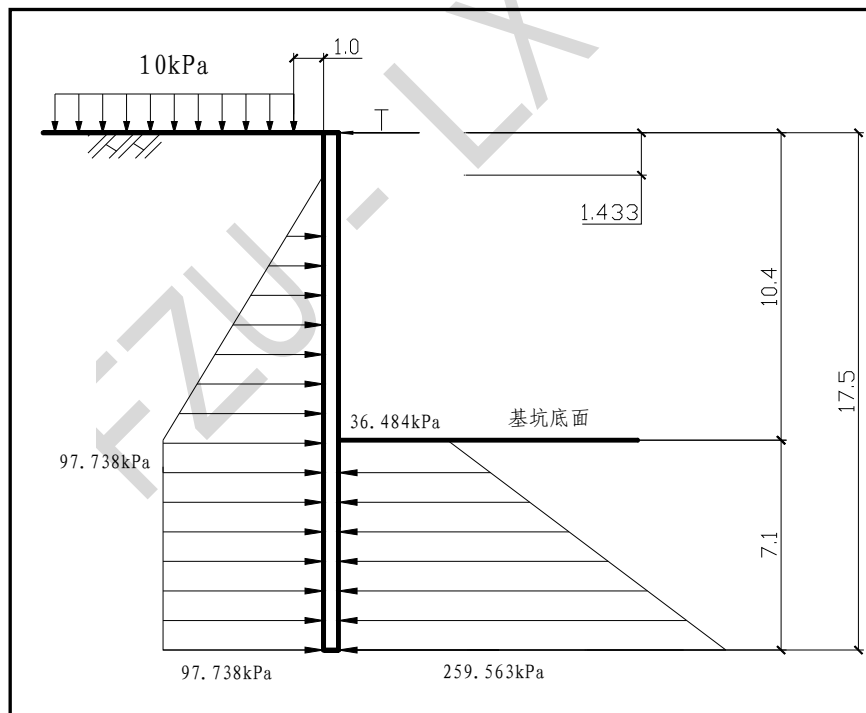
开挖至 10.4m 的力学计算简图(尺寸单位: m)
